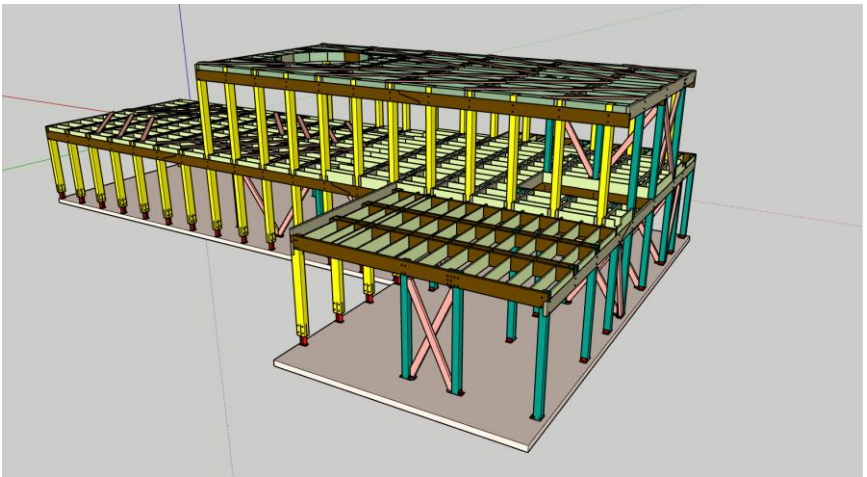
Последовательность монтажа – установка промежуточных балок перекрытия и покрытия
